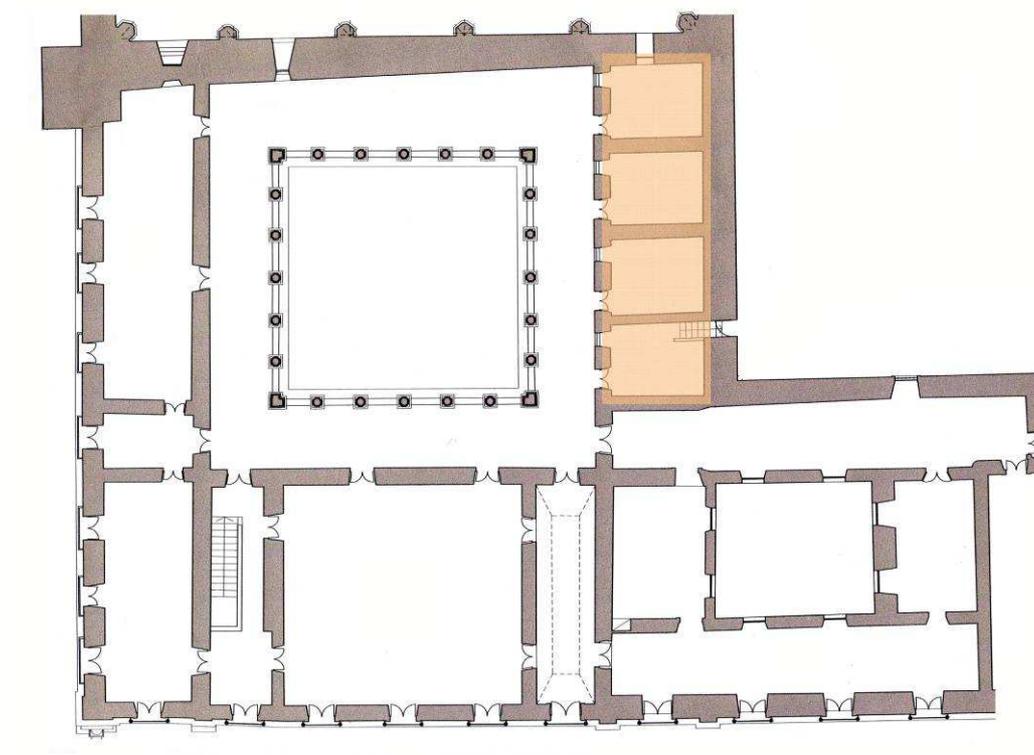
Localização das salas da galeria Sul na planta do piso superior do levantamento de 2003.
